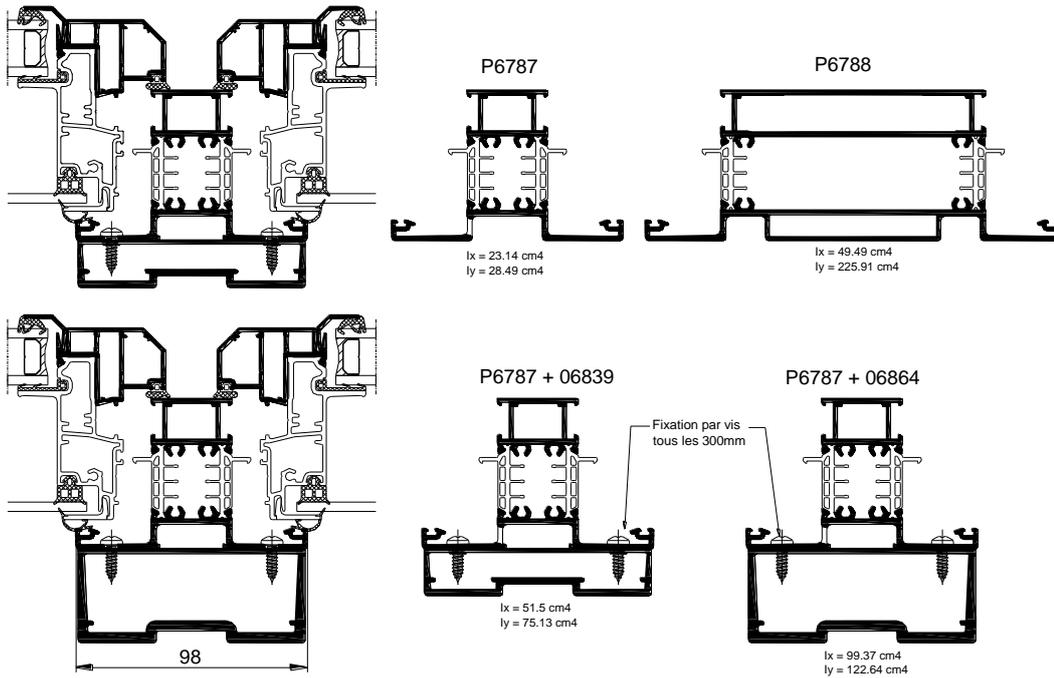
## DETAIL D'ASSEMBLAGE DE L'OUVRANT
